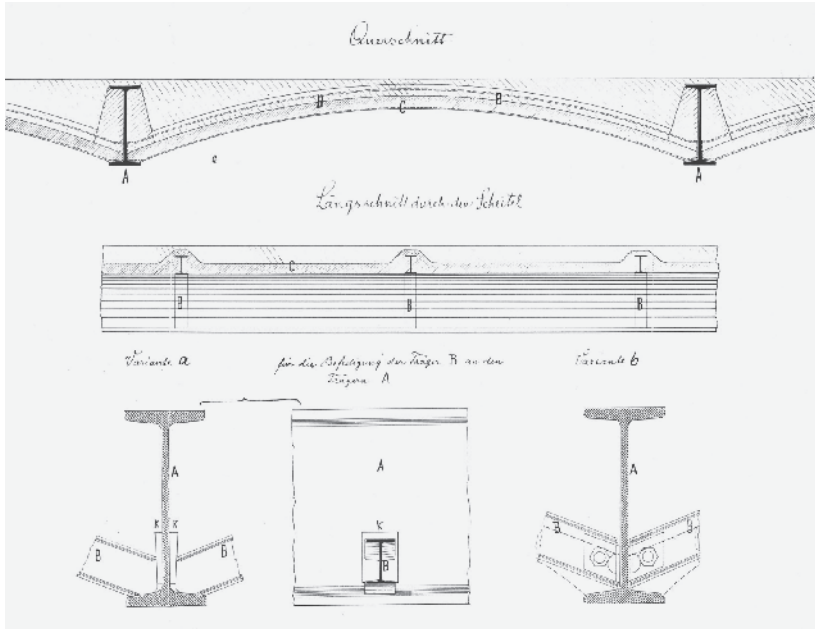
Brevetto per l'Europa N. 42/3211 del prof. Joseph Melan (1892), riferibile come la «realizzazione di soffitti con collegamento di travi in ferro con volte in calcestruzzo»: dall'alto, sezione trasversale del sistema, sezione longitudinale su una generatrice, particolare del collegamento tra le travi di orditura e gli archi in ferro.
